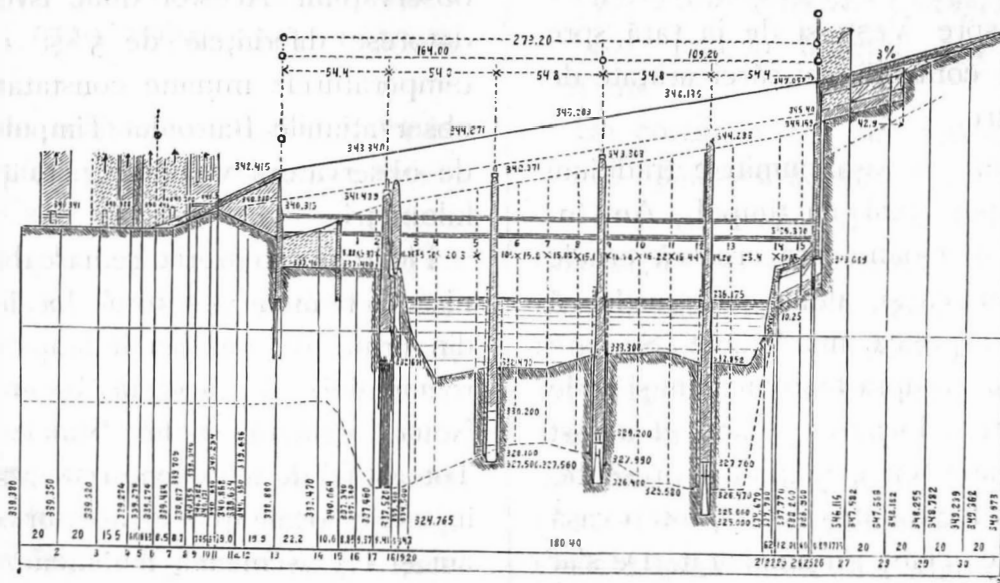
Profil longitudinal al noului pod între Braunau și Simbach.
